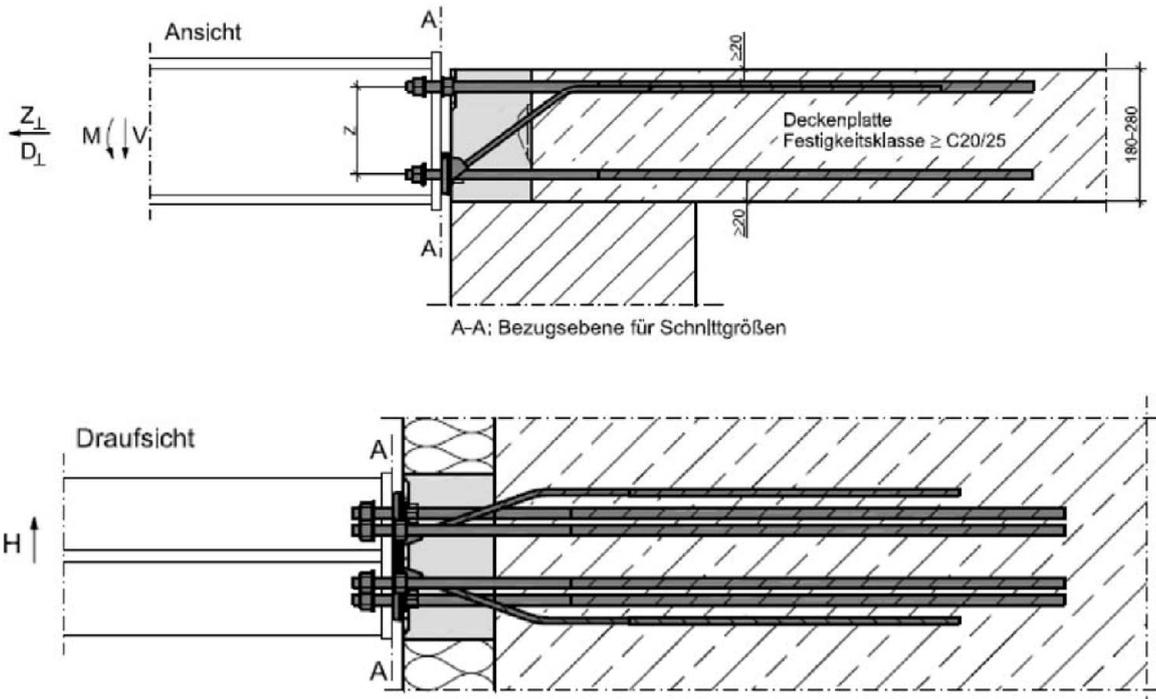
und 70: Schöck Isokorb® XT Typ SK-MM1-VV1, Schnittgrößendefinition
